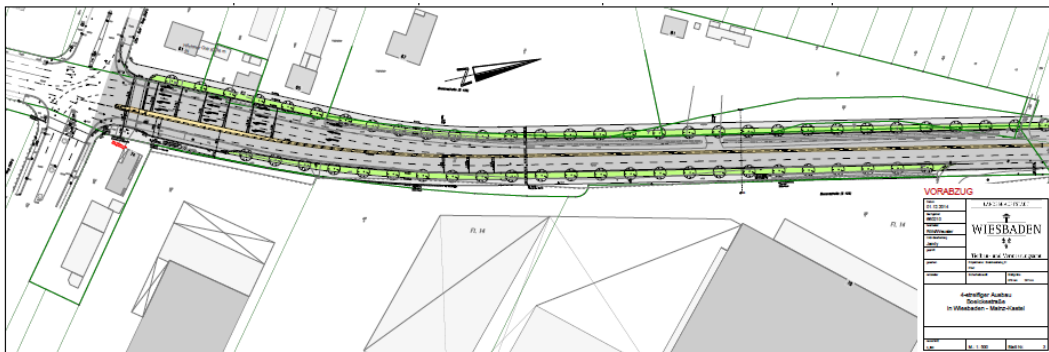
Auszug aus dem Lageplan, Tiefbauamt, 2014
